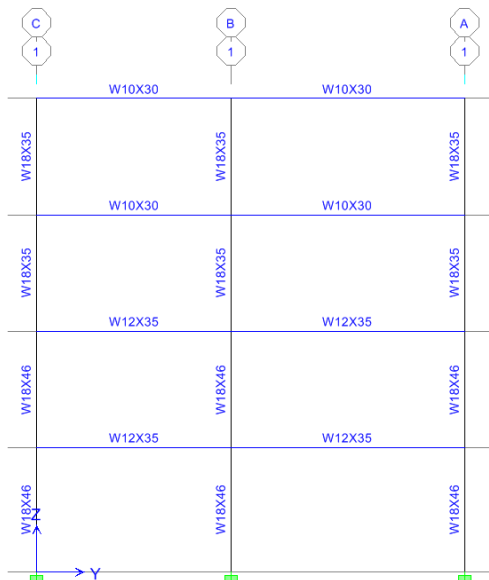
Alzada de los planos estructurales 1 y A.
